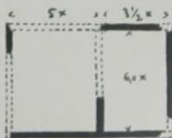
Grundriß einer Hausruine aus Kohaito. (Ruine 2.)
